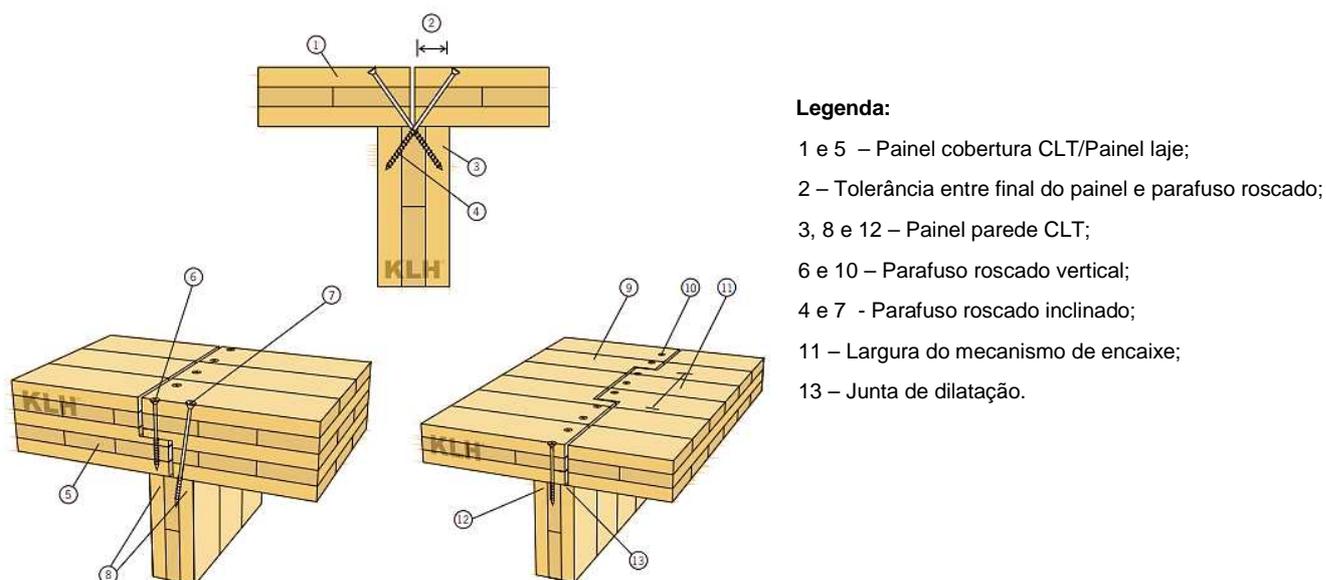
Ligação coberturas planas (parafusos roscados) [24]
